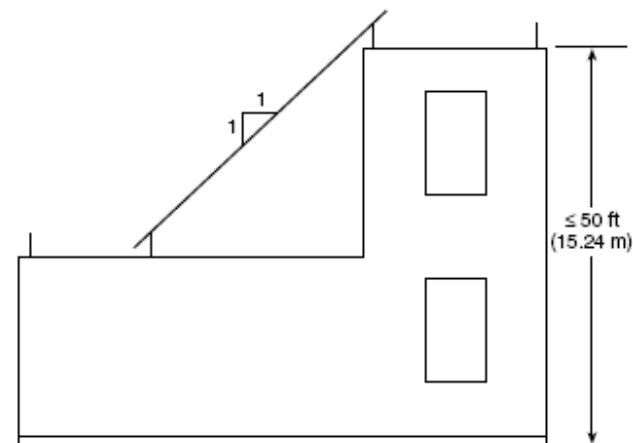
Protección de techo inferior en edificio de techo plano con altura $\leq 15,24$ m.
